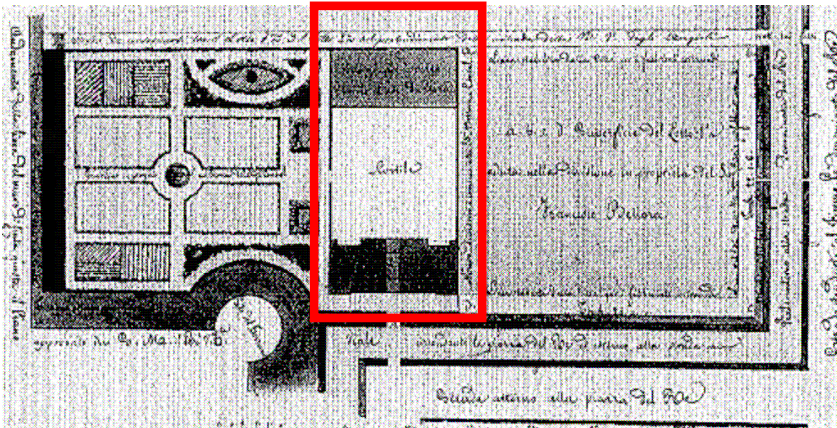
G. Lombardi - Piano di suddivisione dell'isolato di San Ferdinando nelle proprietà Bellora e Consul, 1822
